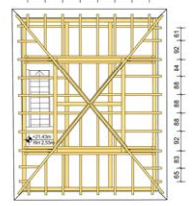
Grundriss Dachkonstruktion Turm 5, DG, M 1:100
